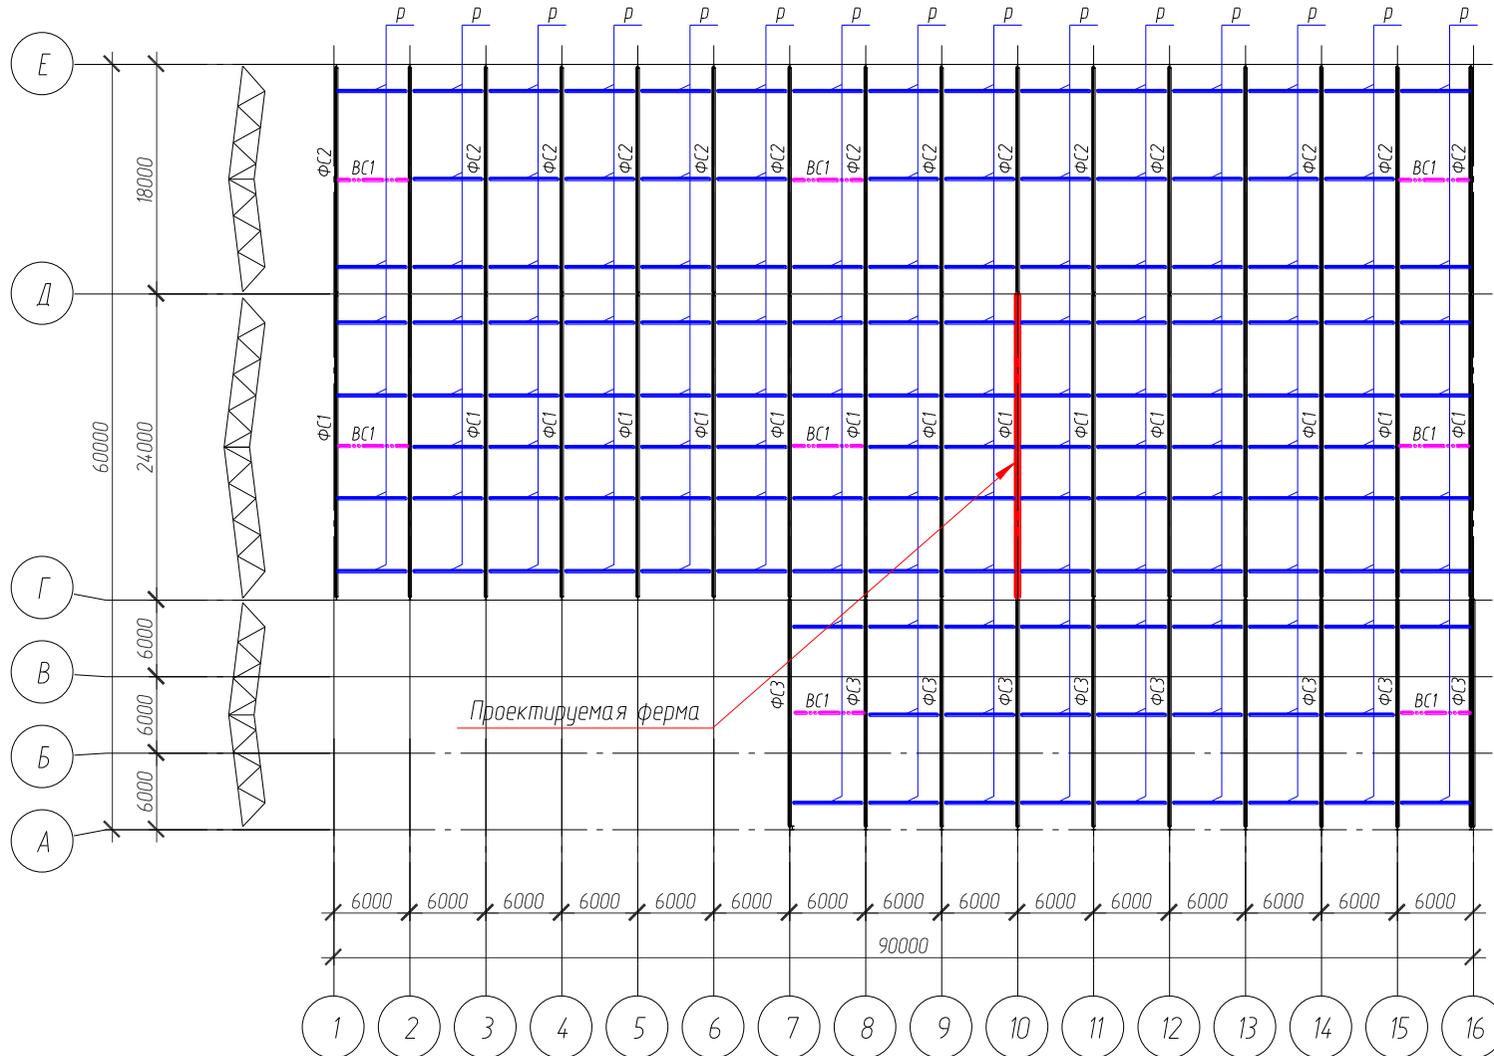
Схема связей и распорок по нижним поясам ферм
